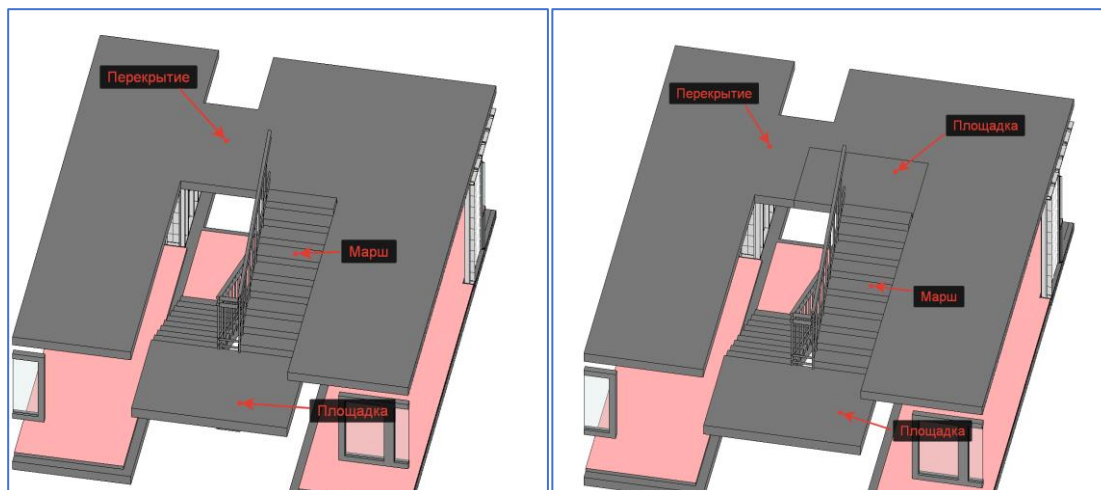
Пример разделения элементов конструктива перекрытия и площадки
